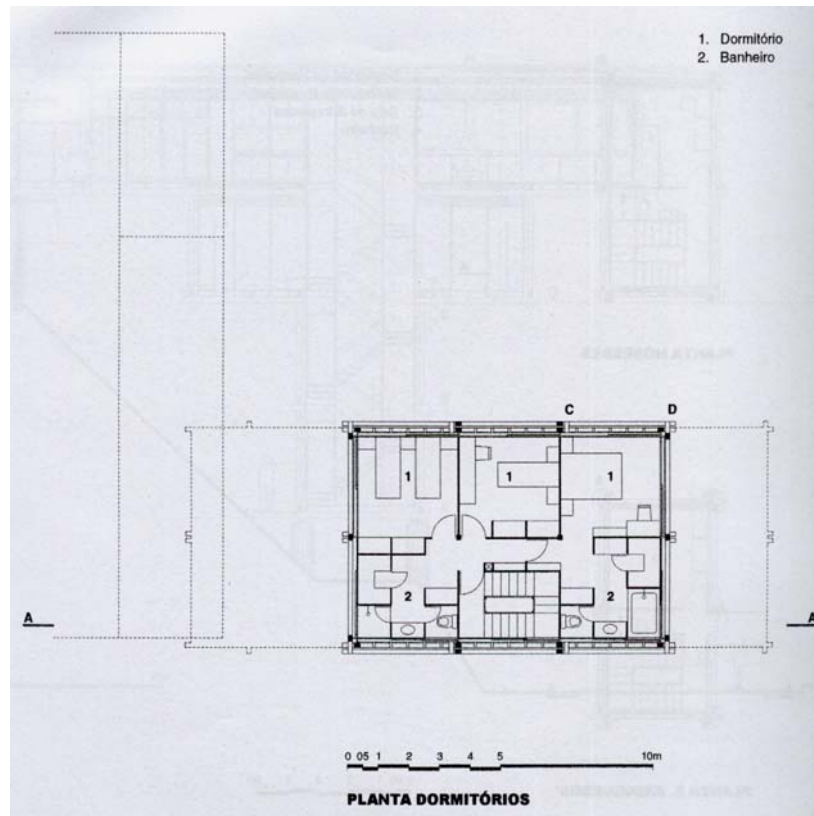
Planta: dormitórios. Fonte: arquivo do arquiteto (2001)
